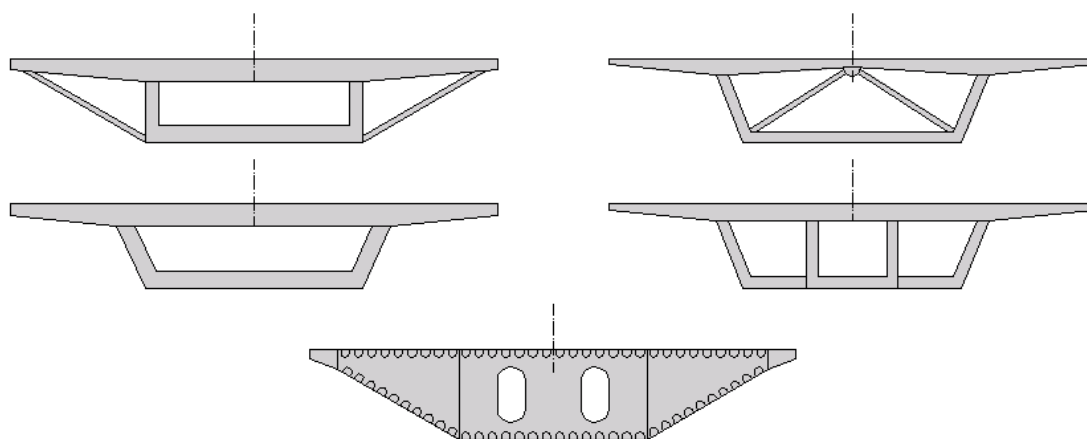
Secções indicadas para possível atirantamento no eixo da secção transversal, secções de elevada rigidez à torção, (adaptado [8])
